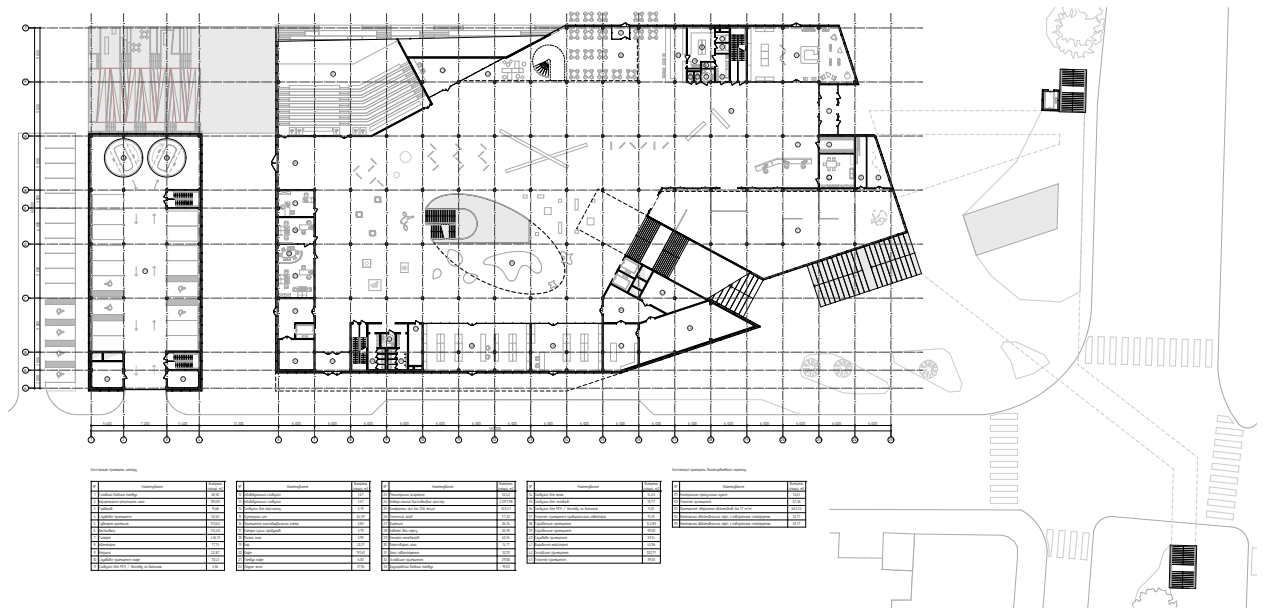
План 1-го поверху на відм. 0,000
